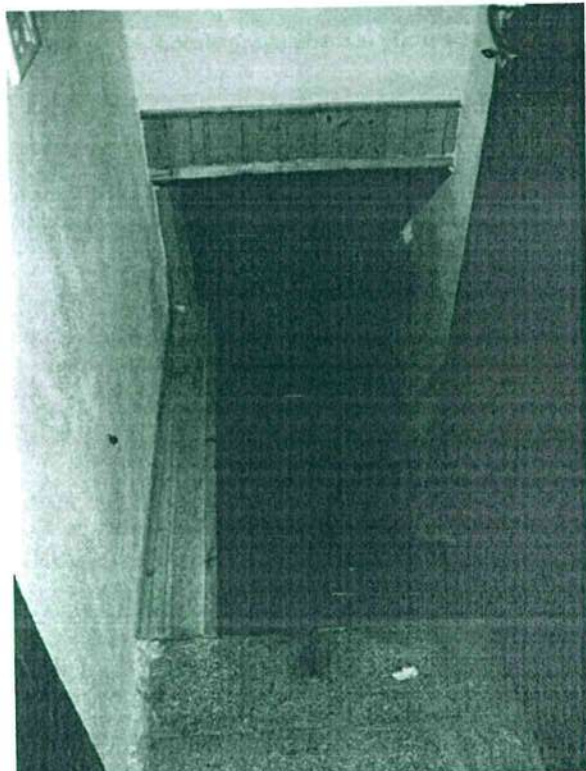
Scala che porta dal piano terra al seminterrato.
